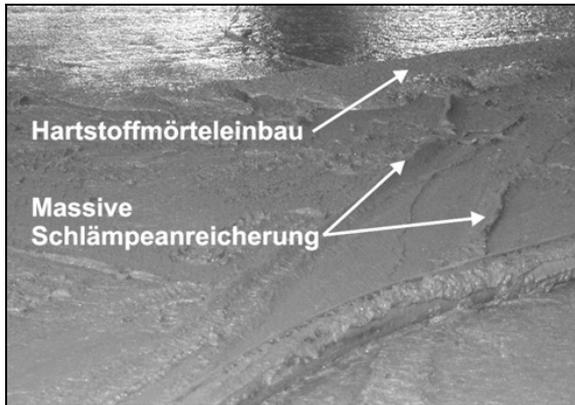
Schlämpeanreicherungen auf der Betonoberfläche unmittelbar vor dem Einbau der Hartstoffmörtelschicht
